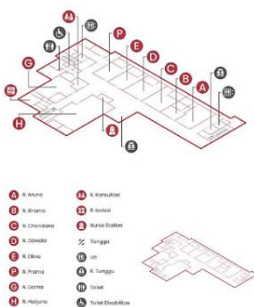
Denah Bangunan RSJP Paramarta (Lantai Semi-Basement)
